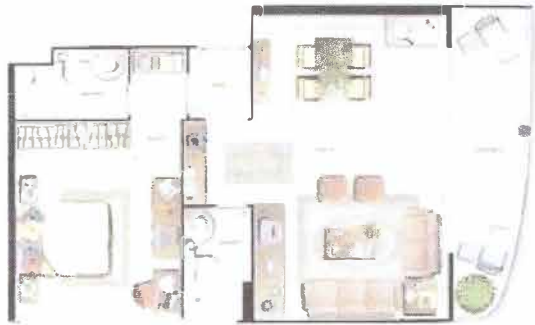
Planta Baixa Típica Coluna 02 – Edifício Transamérica Flat – apto. tipo Pool
